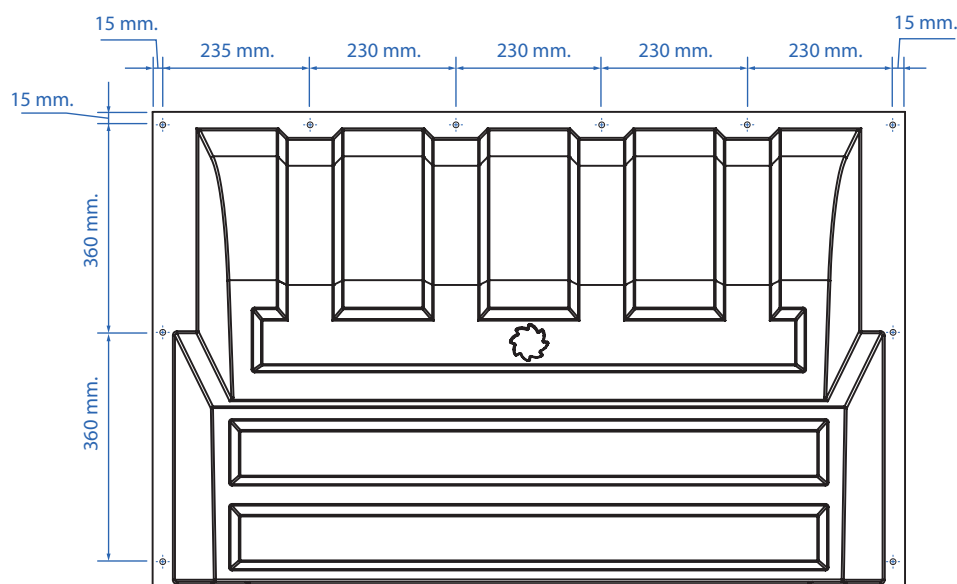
Lugar de colocación de los tornillos, las arandelas y los tacos para la pared de hormigón o ladrillo.
